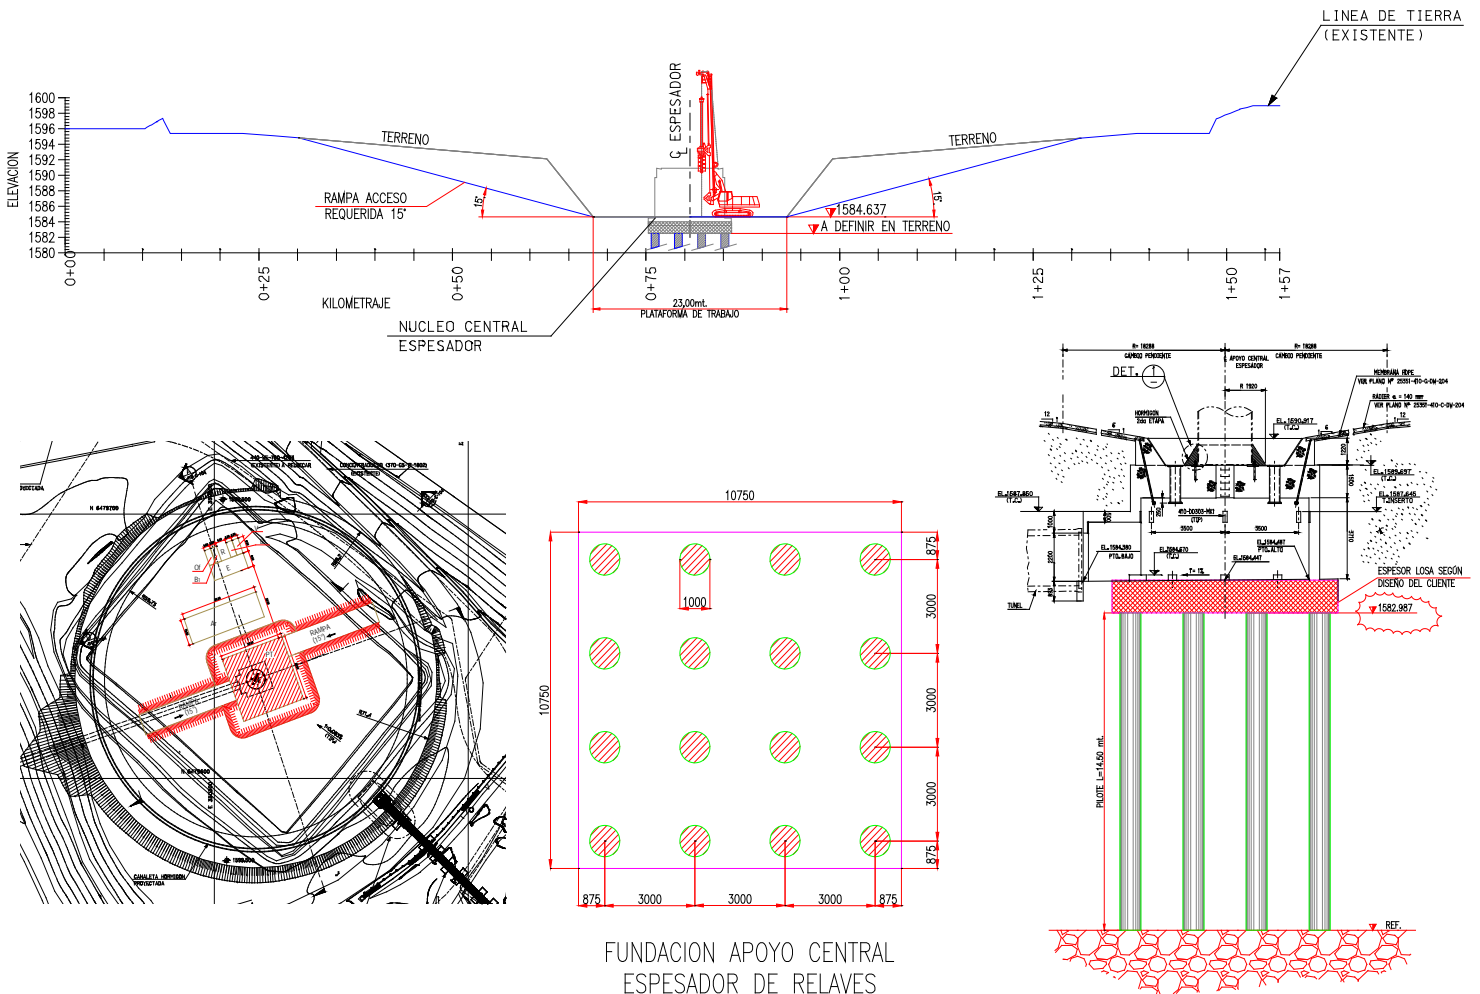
Esquemas y Planos Referenciales del Proyecto de la Fundación del Núcleo del Espesador
